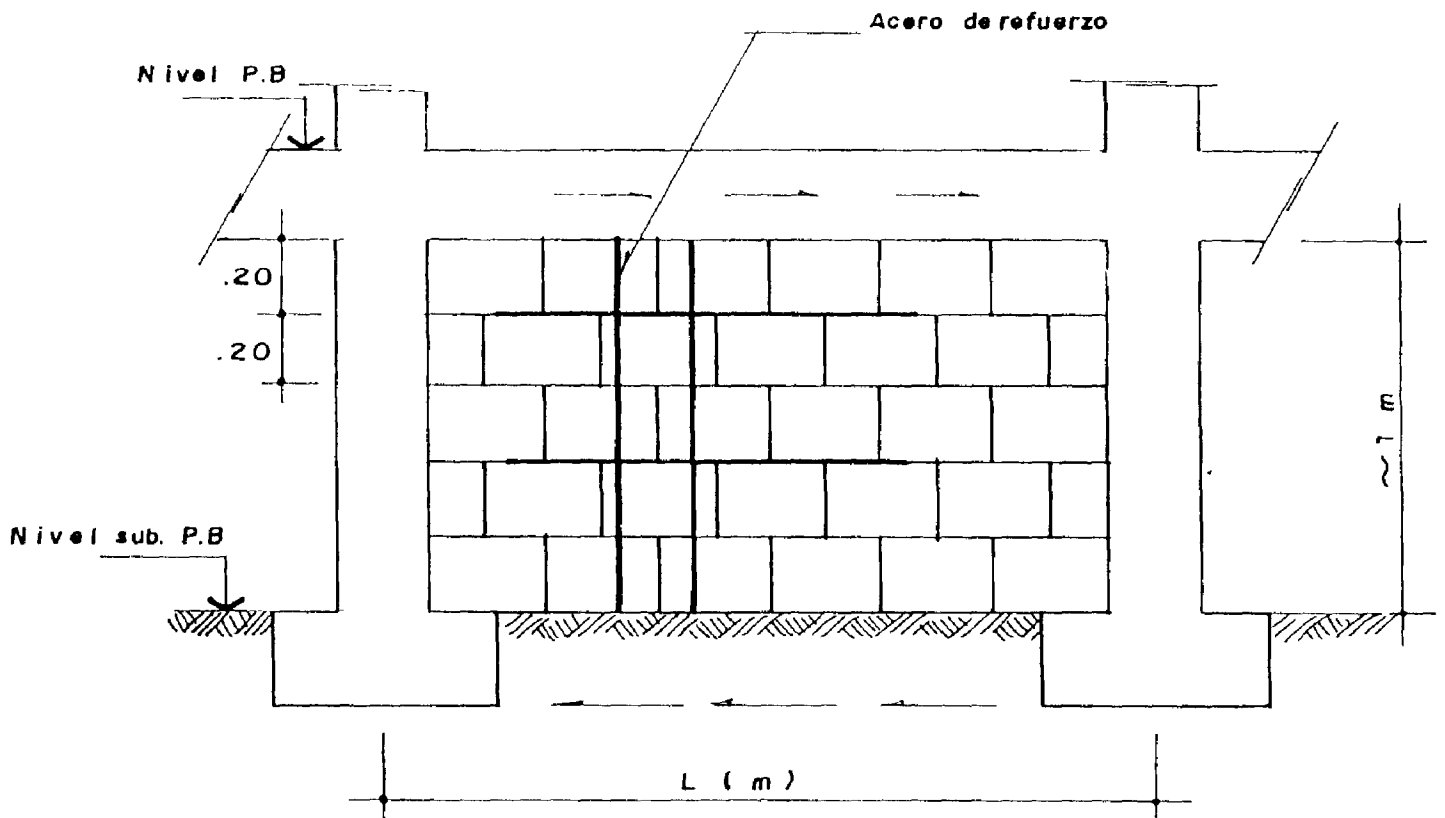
ESQUEMA DE MURO DE MAMPOSTERIA REFORZADA A NIVEL DE SUBPLANTA BAJA
